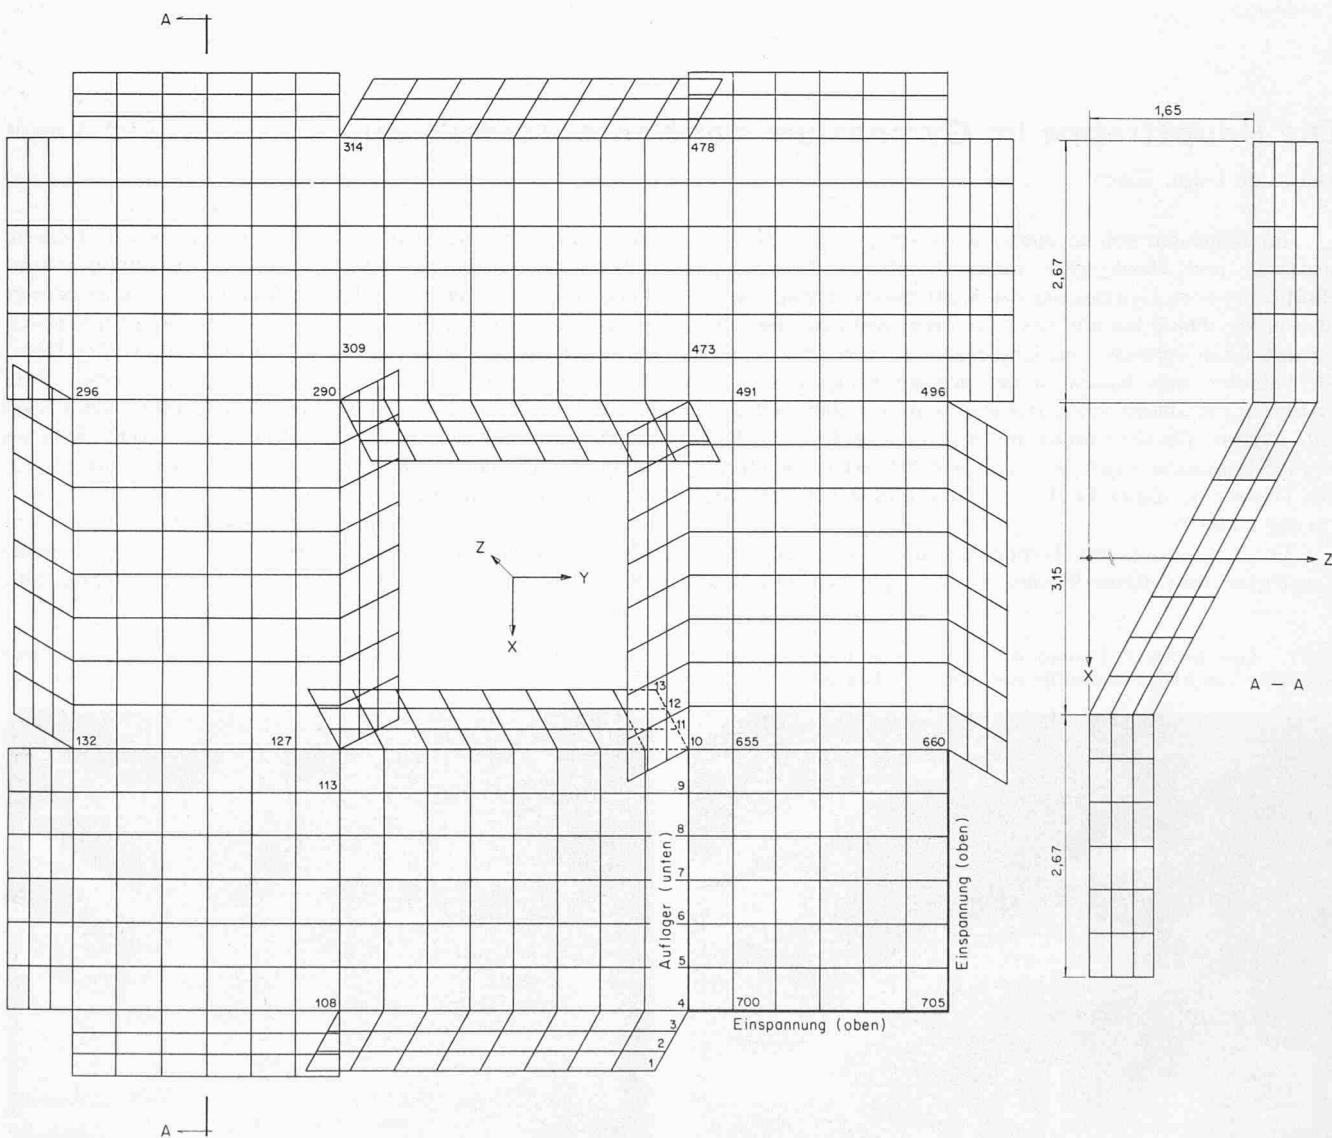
Für die definitive Berechnung wurde die Treppe in 636 Elemente mit 705 Knoten eingeteilt. Die Faltwerkswirkung wie auch die zweiseitige Einspannung in der oberen Decke konnte somit genau erfasst werden. Links Grundrisschema, rechts schematisierter Schnitt A-A
